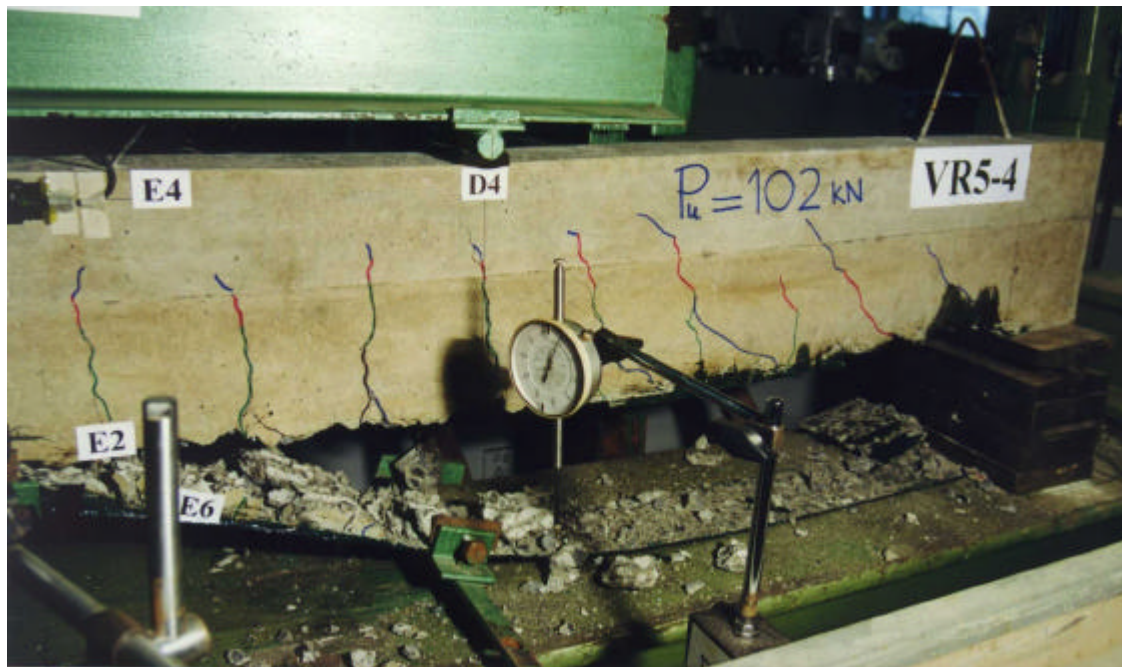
Ruptura por descolamento na viga reforçada com quatro camadas
